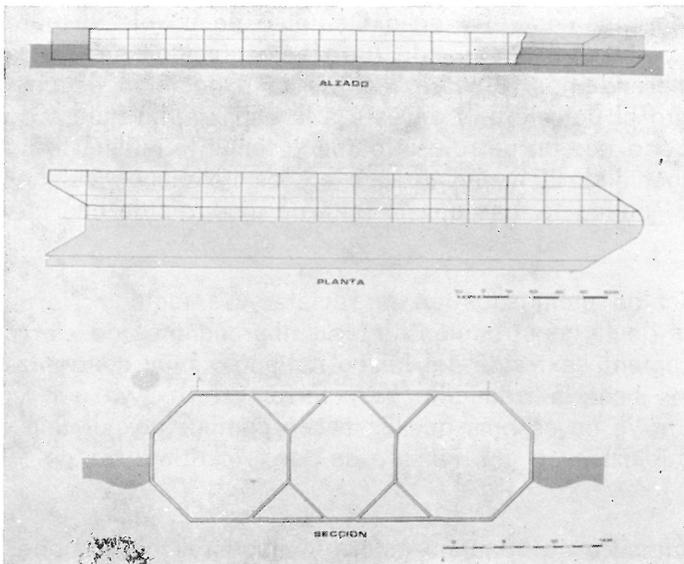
Posible solución de gabarras graneleras de hormigón pretensado.
